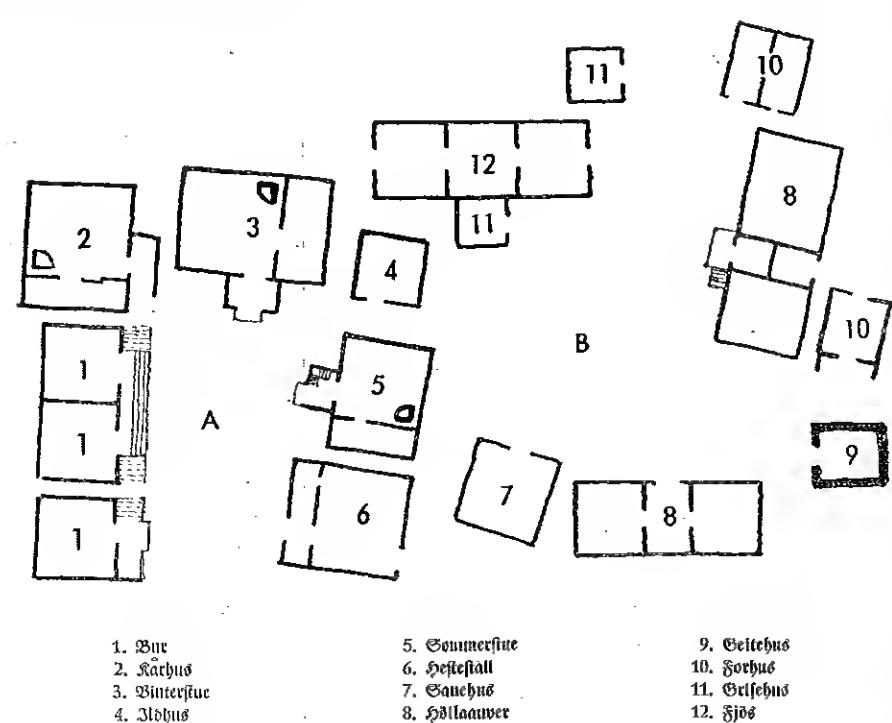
Grundriss eines altnorwegischen Bauernhauses. (Am Hofe Røste in Sudbrandebalen.) (Nach Bisted.)
